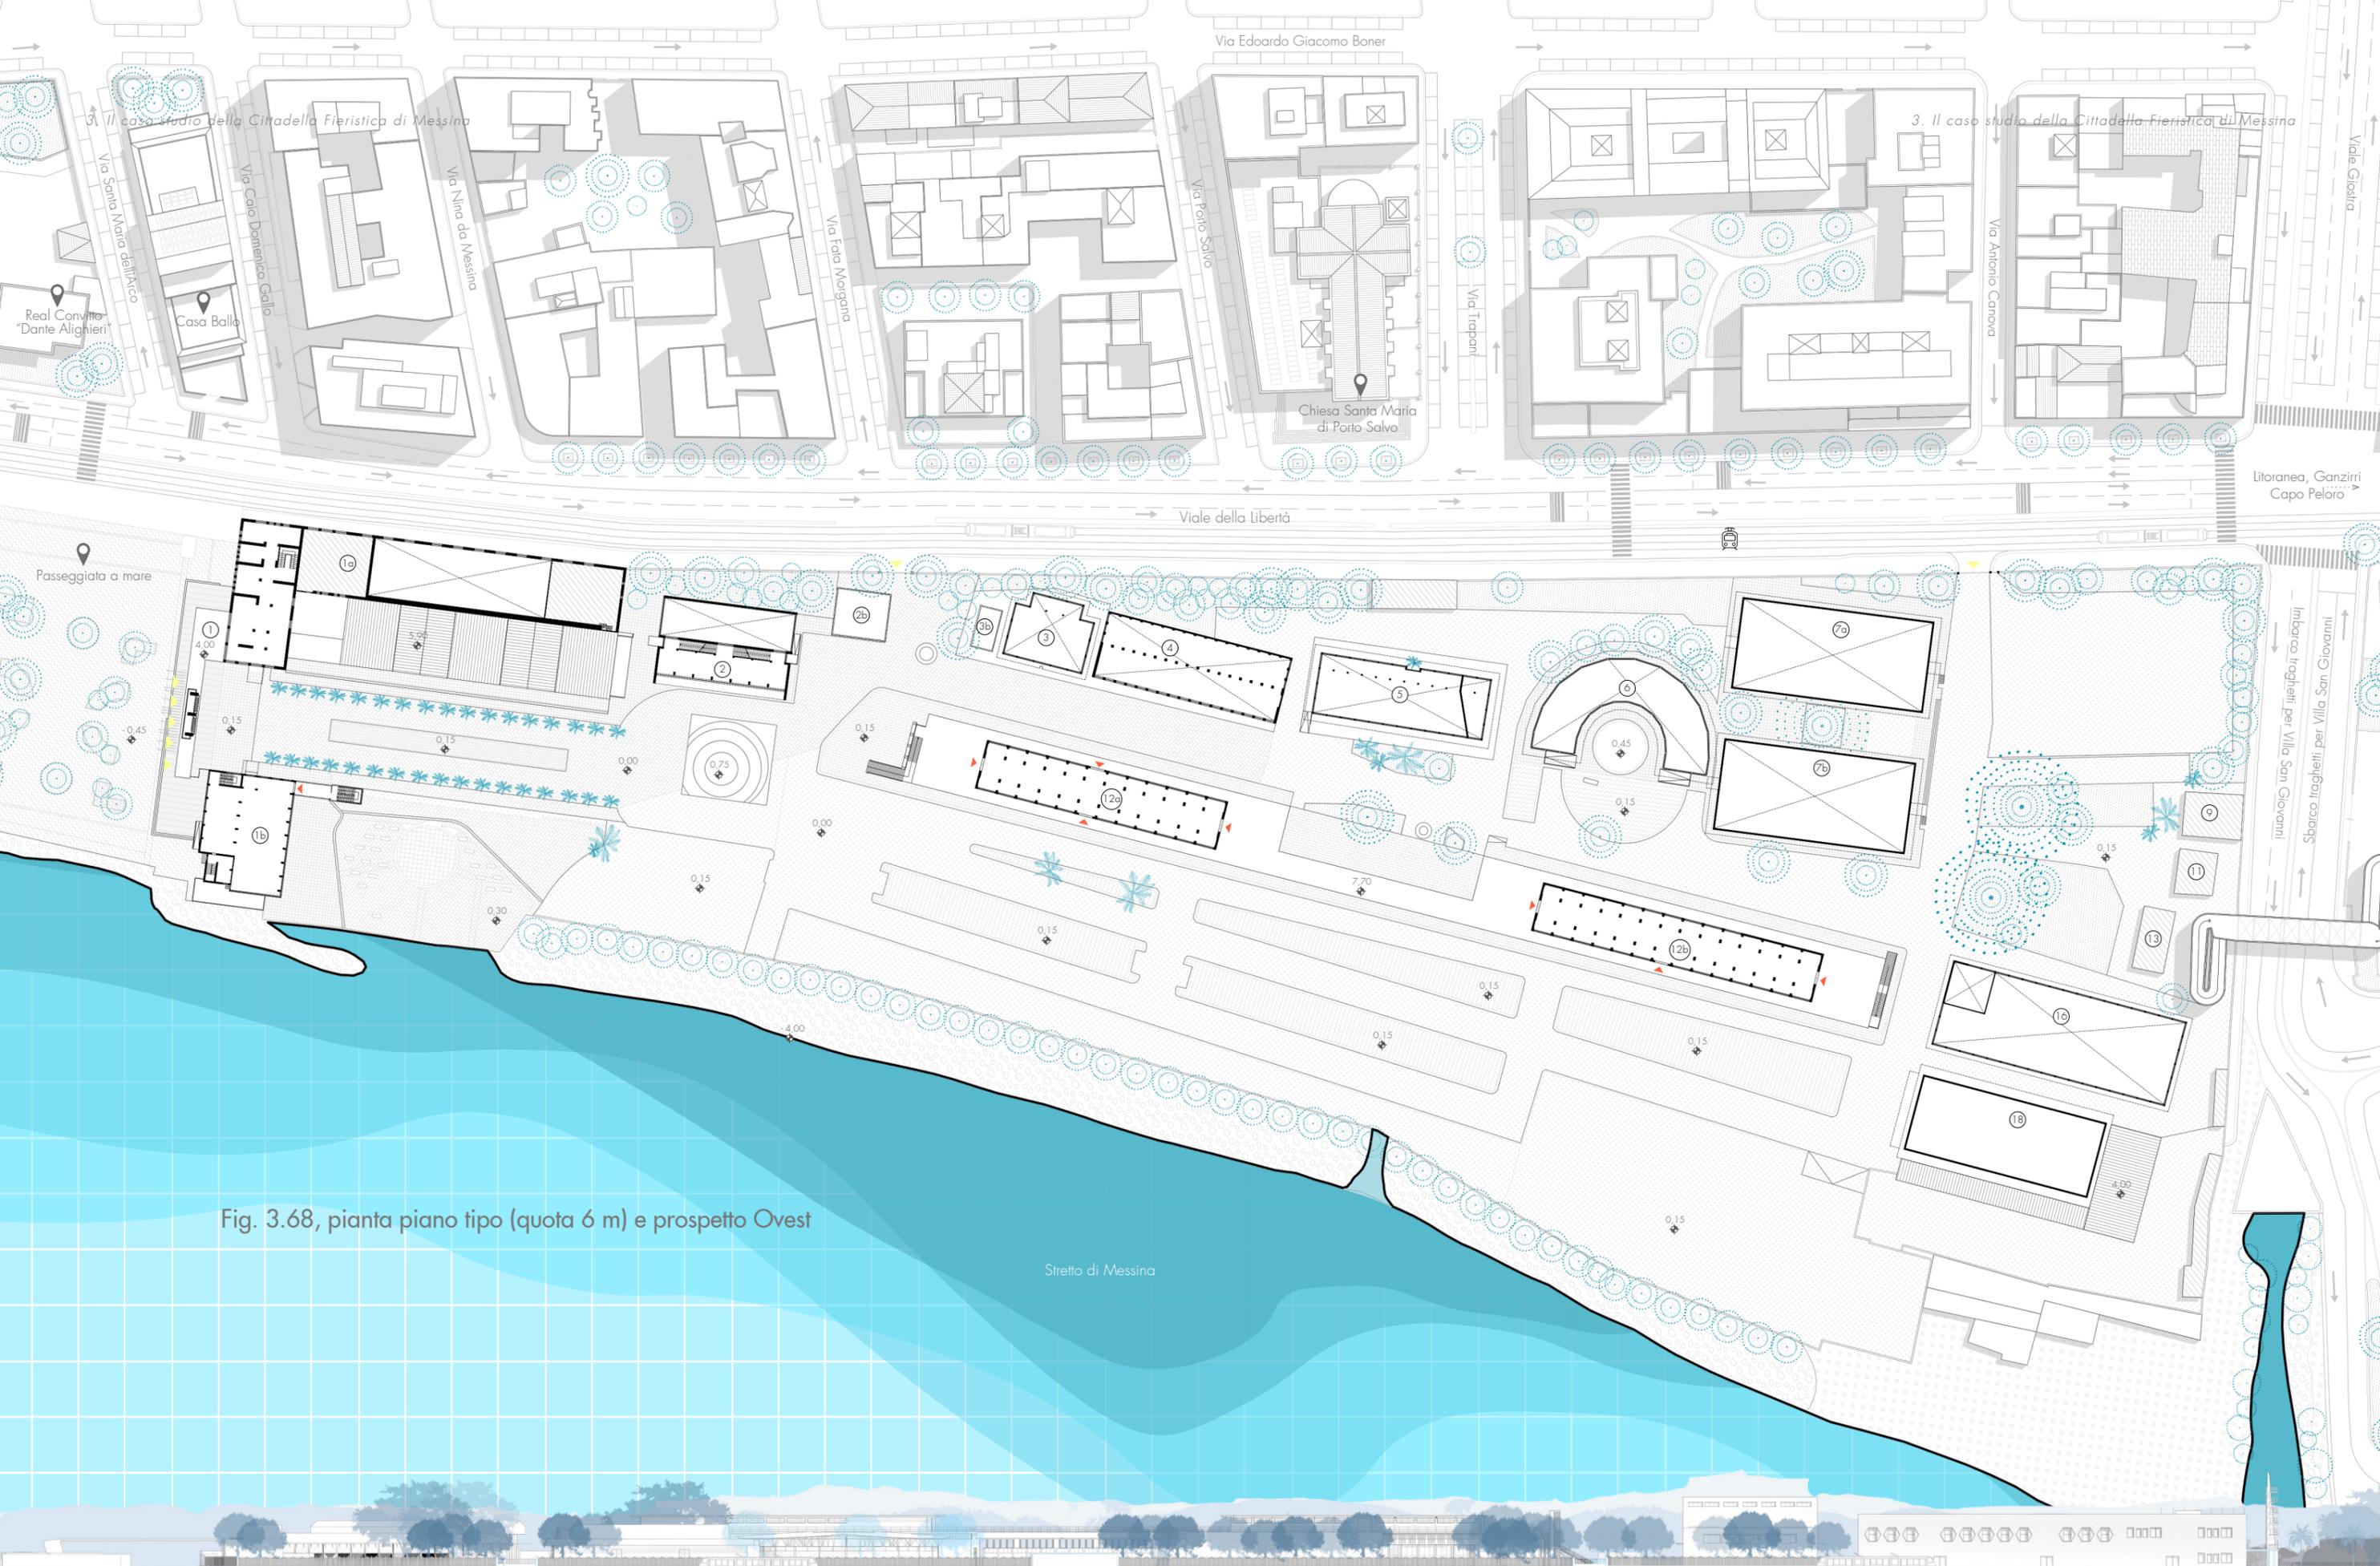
, pianta piano tipo (quota 6 m) e prospetto Ovest
